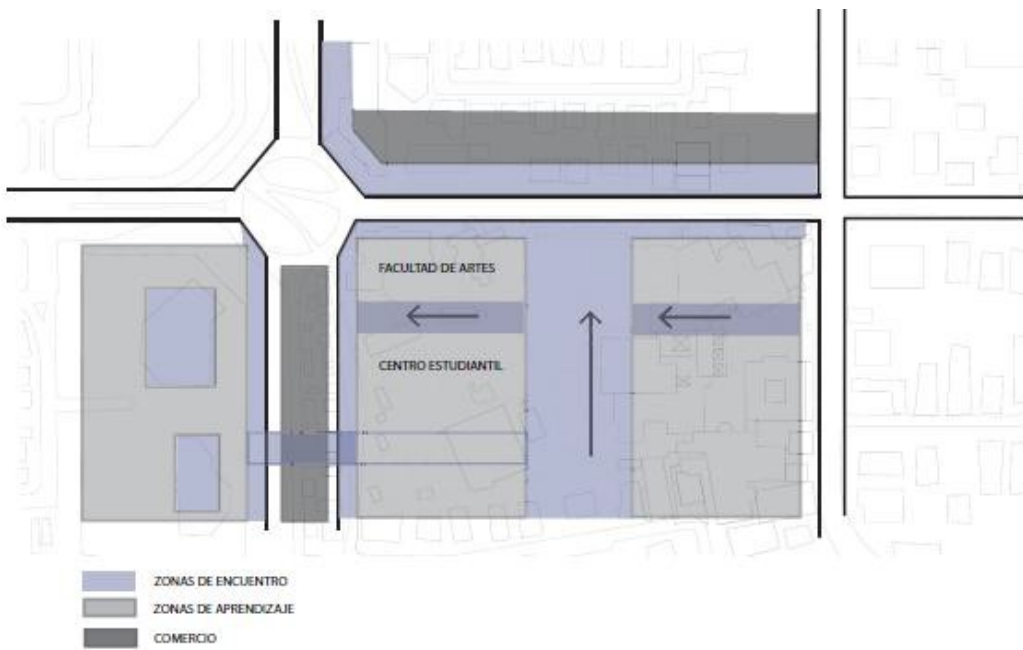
Diagrama plan para la USFQ en planta. Elaboración grupal
